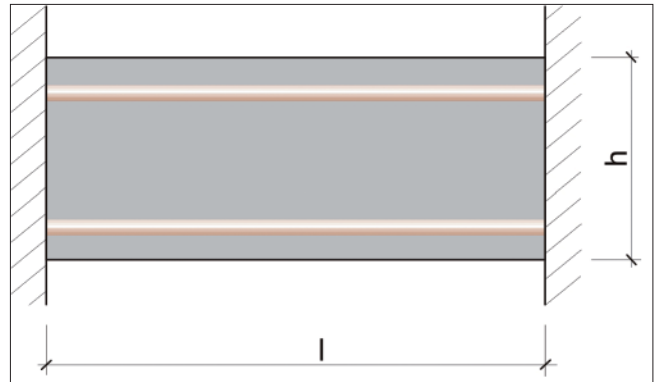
Modell mit starrem Verbund zwischen Beton und Bewehrung
